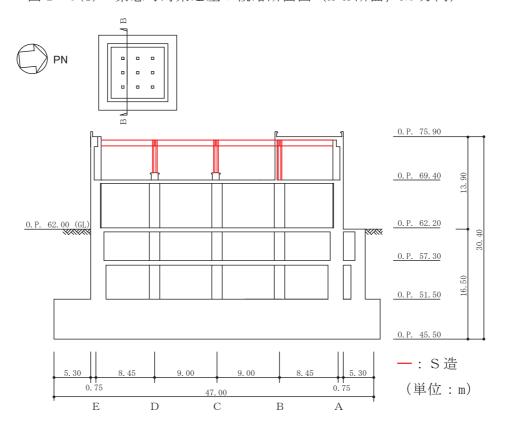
(2) 緊急時対策建屋の概略断面図 (B-B 断面, EW 方向)
